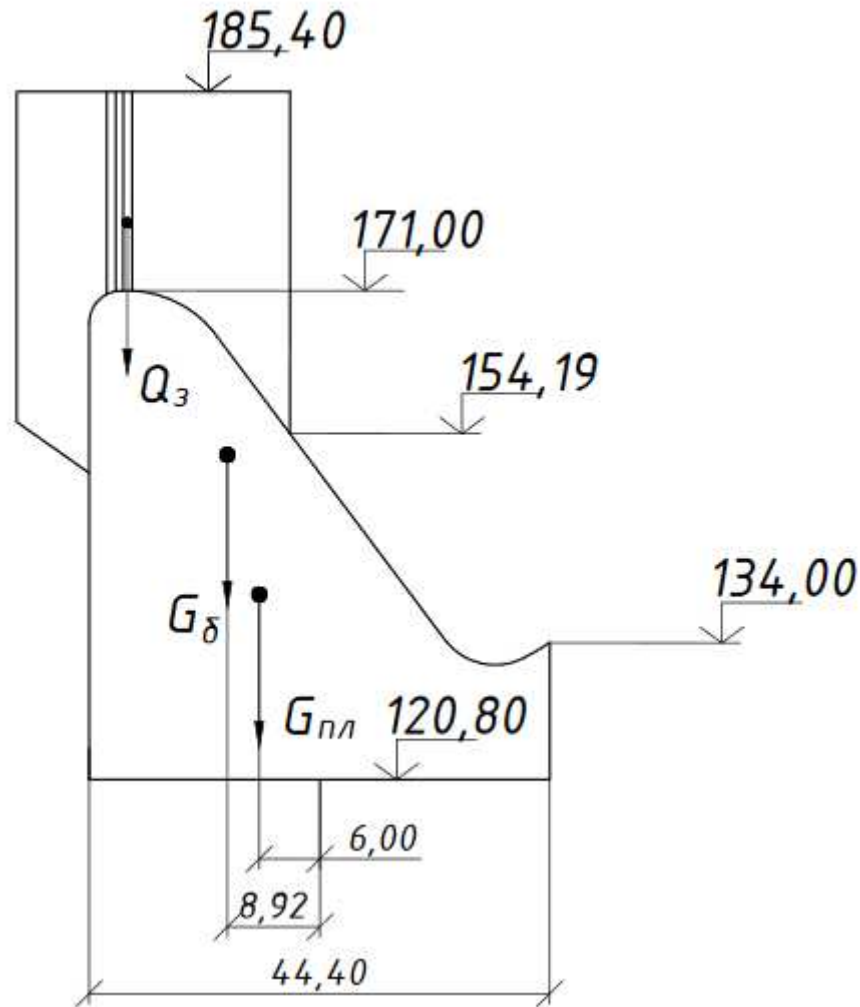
Поперечный разрез плотины и быка при определении площади поперечного сечения
